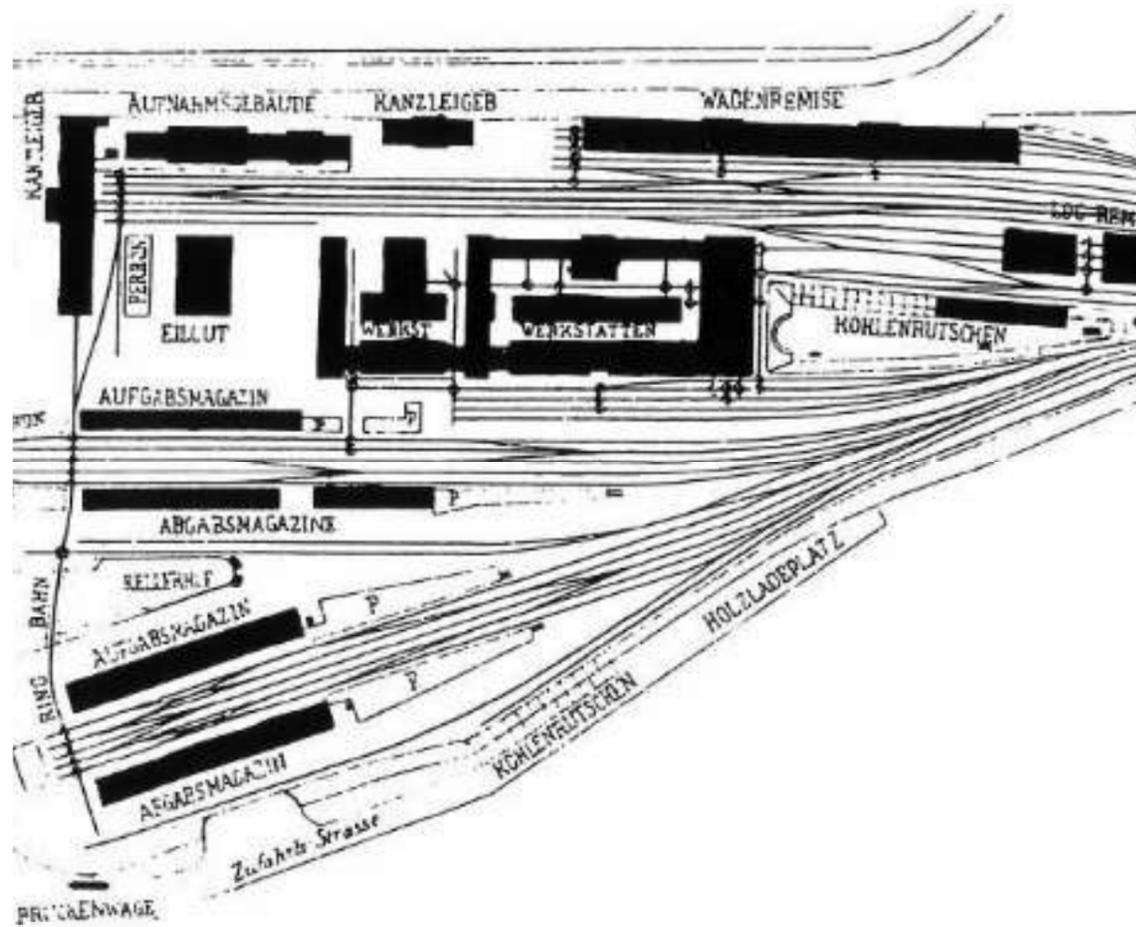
Lageplan Erster Nordbahnhof, 1850
